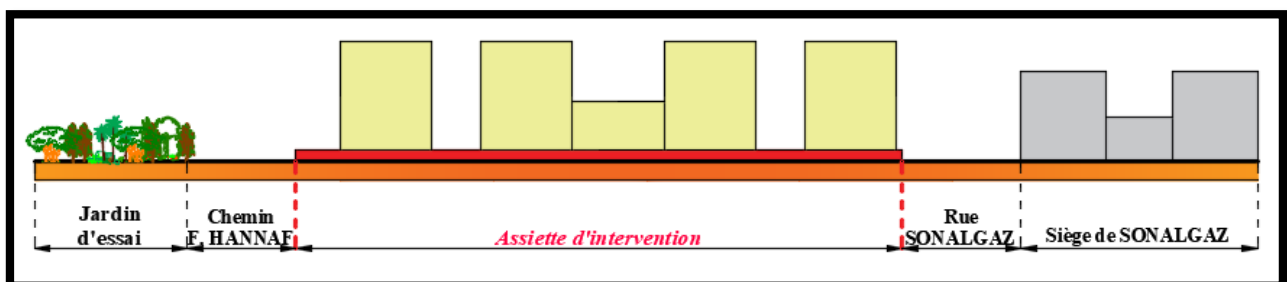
Coupe schématique longitudinale BB du site d'intervention
